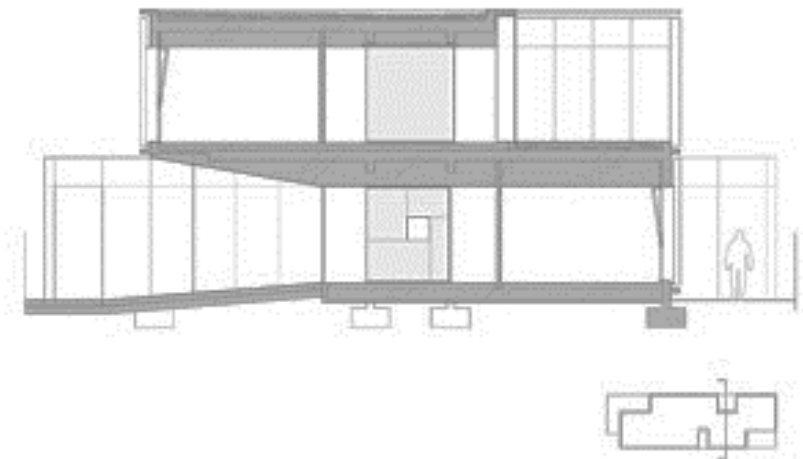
Corte transversal 1. Elaboración: Javier Larraz
